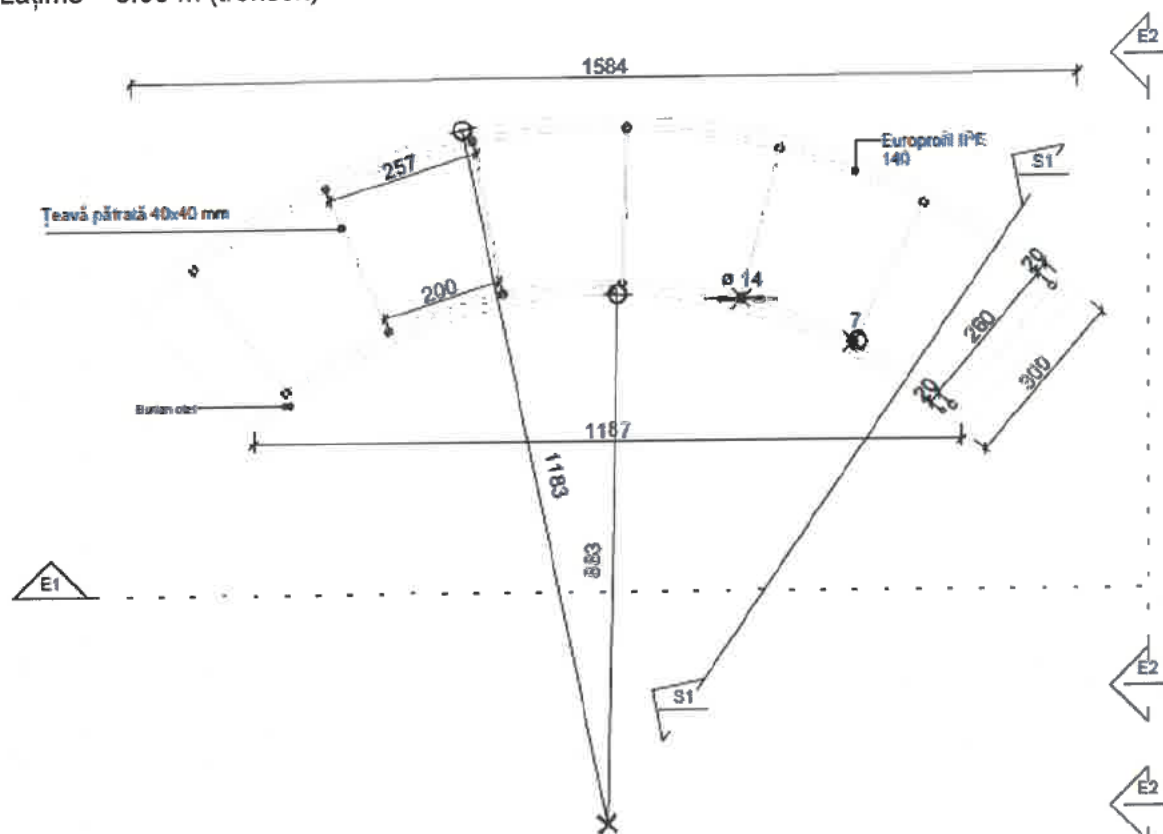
Planul de structură de rezistență al pavilionului propus
